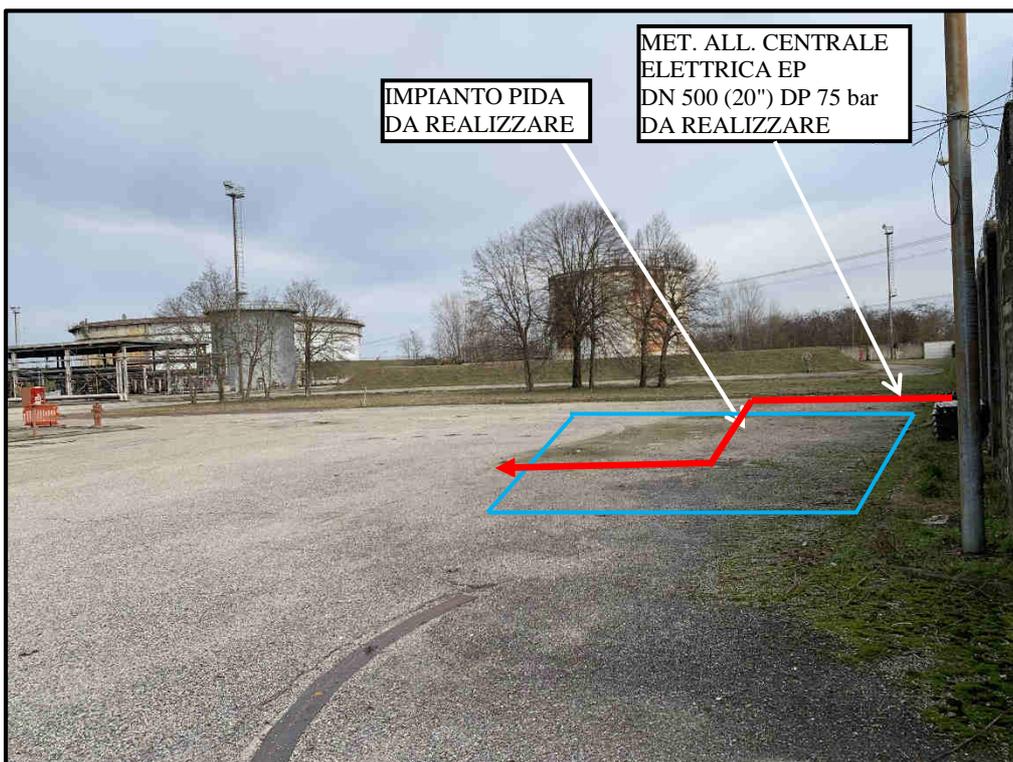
Vista dell'ubicazione dell'impianto PIDA nella proprietà dell'utente finale.
